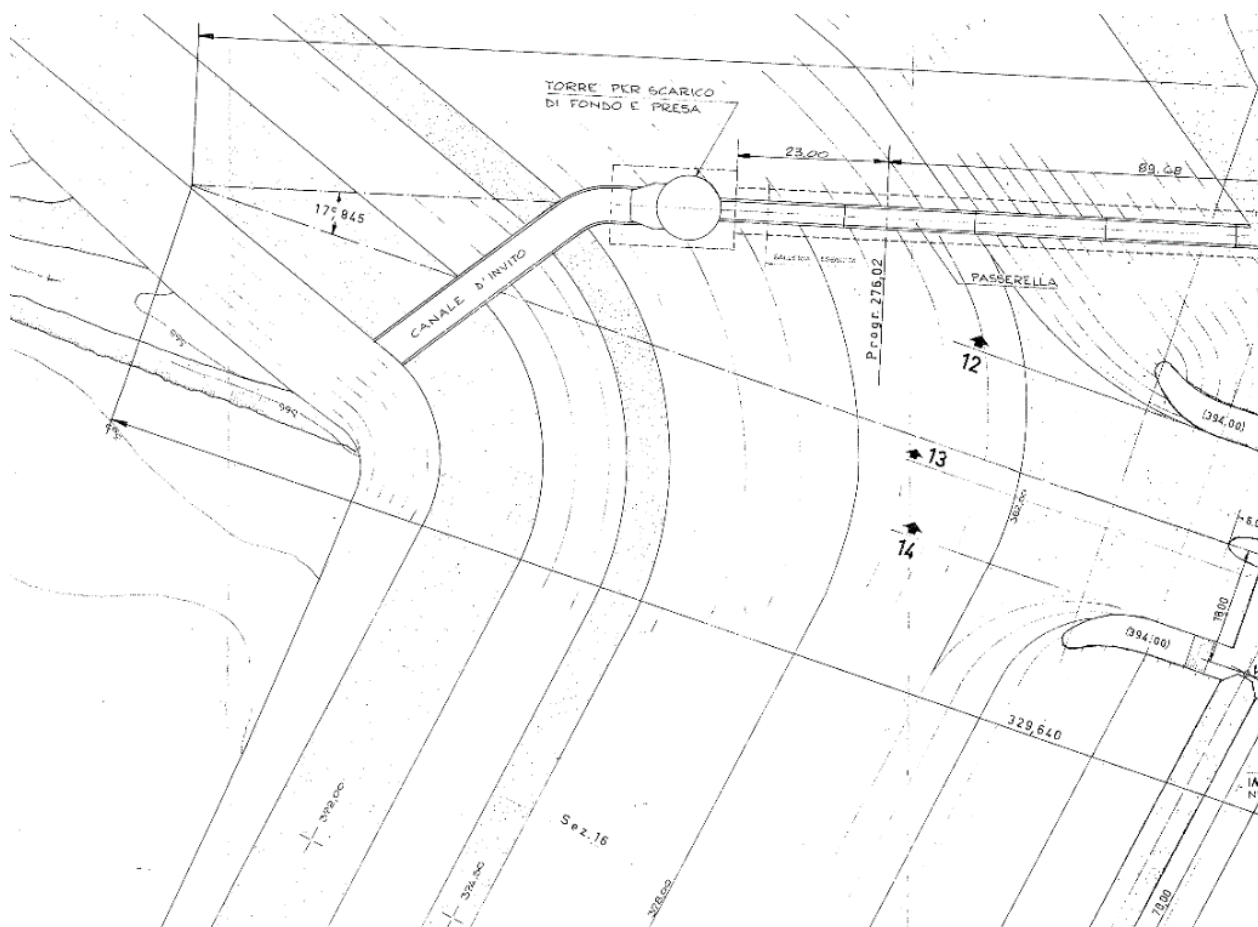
PLANIMETRIA DELLO SCARICO DI FONDO COSÌ COME INDICATA NEL PROGETTO ESECUTIVO DEL 1969 (TAVOLA I-10) E A COLLAUDO.
